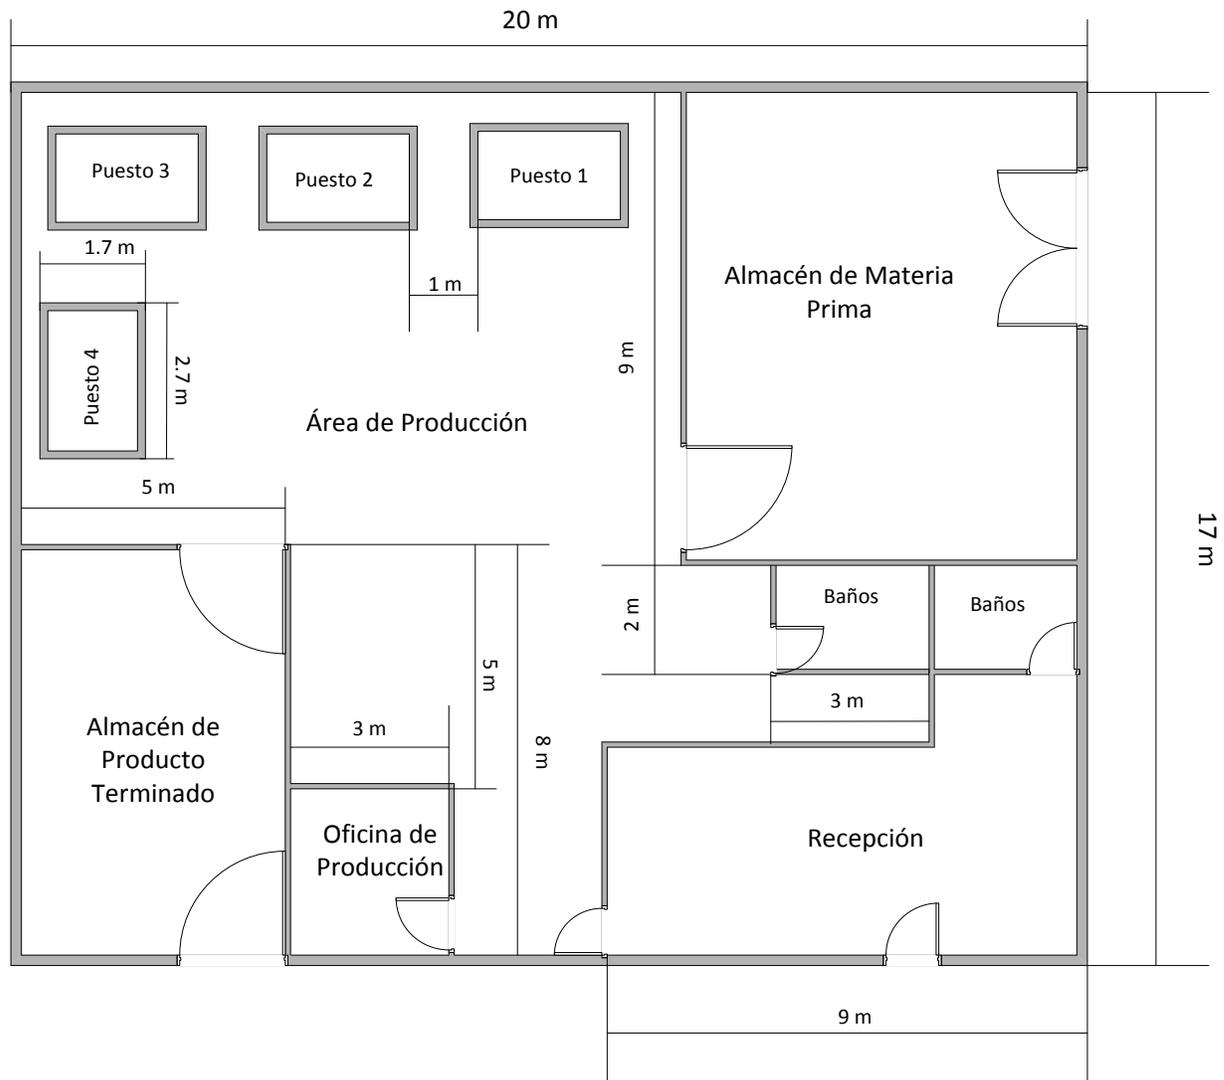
Diseño de Planta propuesto para CLEAN S.A.KM 12
